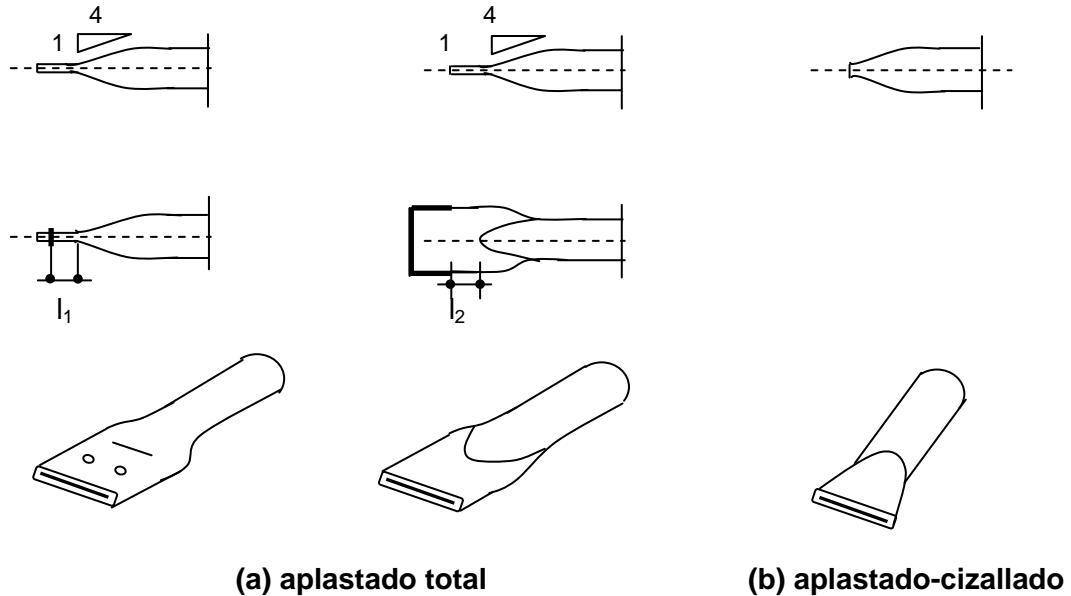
Barras de sección circular con extremos aplastados.
